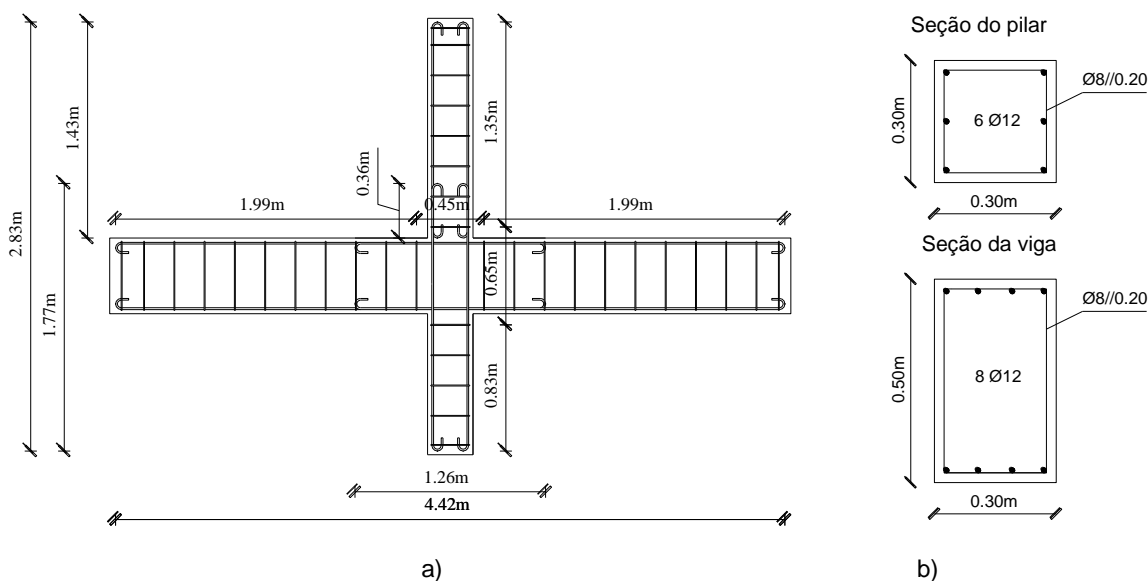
Armadura do provete IPD; a) em planta; b) em corte.
